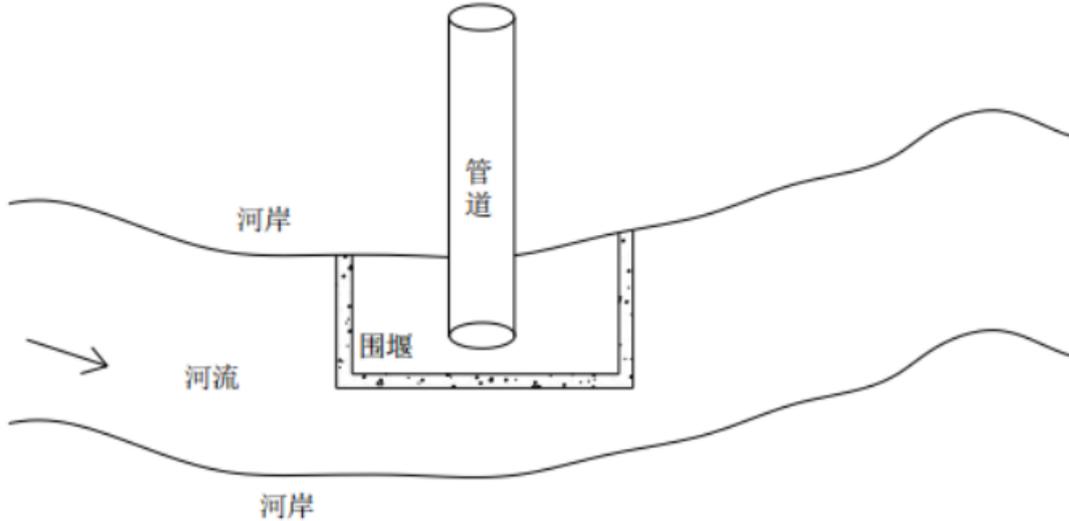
围堰导流开挖管沟法施工断面示意图
